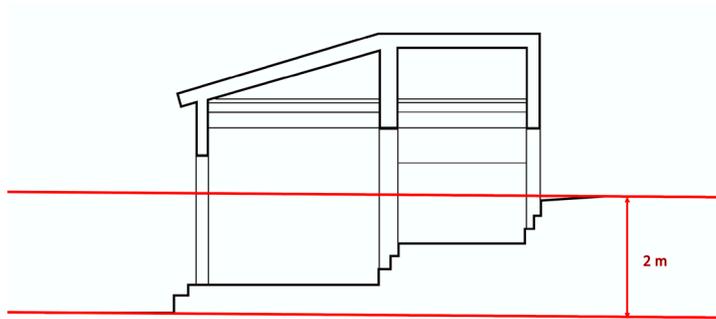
Ricostruzione in sezione ,ingresso a Propileo sul braccio sud.
